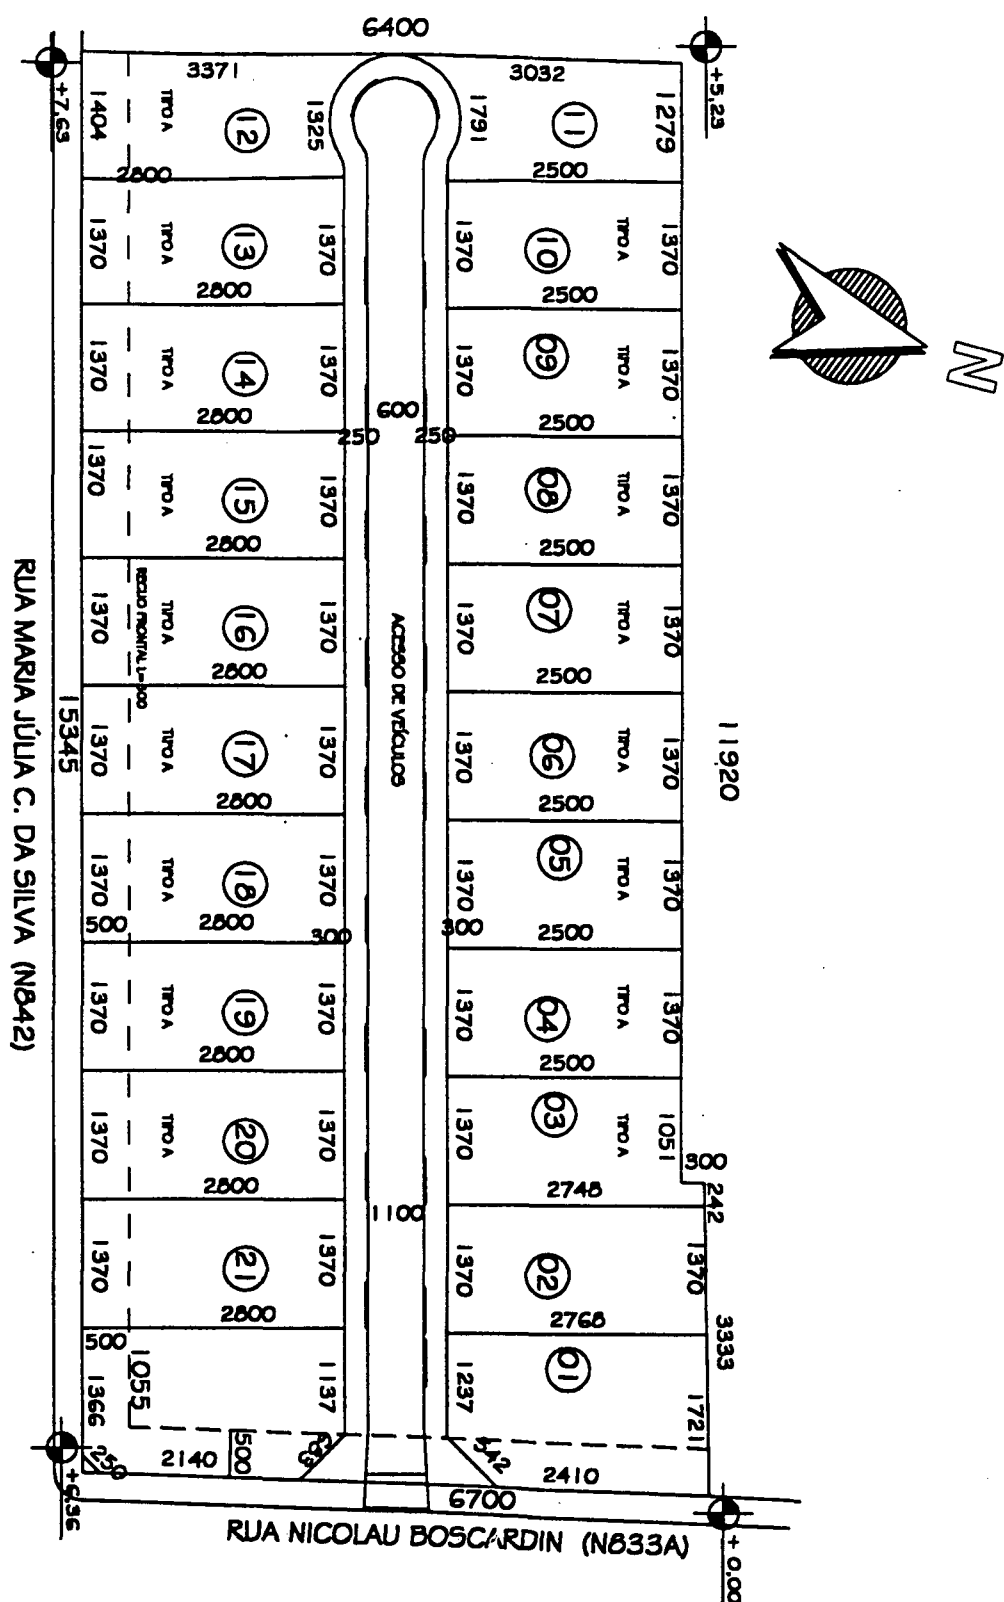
Planta de implantação da obra com o número dos lotes das casas.
